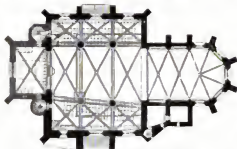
Pfarrkirche in Mögeldorf. Grundriss.
